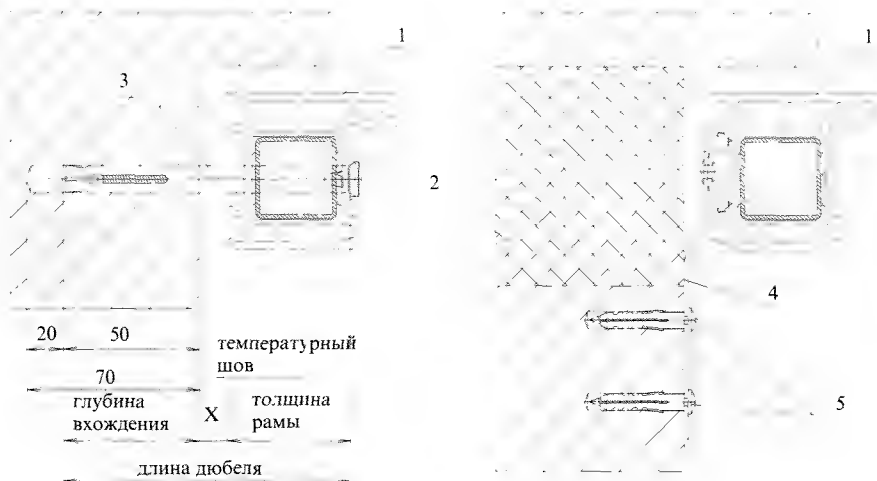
Закрепление окна из ПВХ в наружных стенах различной конструкции: а) сплошная кирпичная стена; б) кирпичная стена с пористым эффективным утеплителем: 1 — оконная рама, 2 — утеплитель в стене, 3 — дюбель, 4 — монтажная пластина, 5 — анкер
